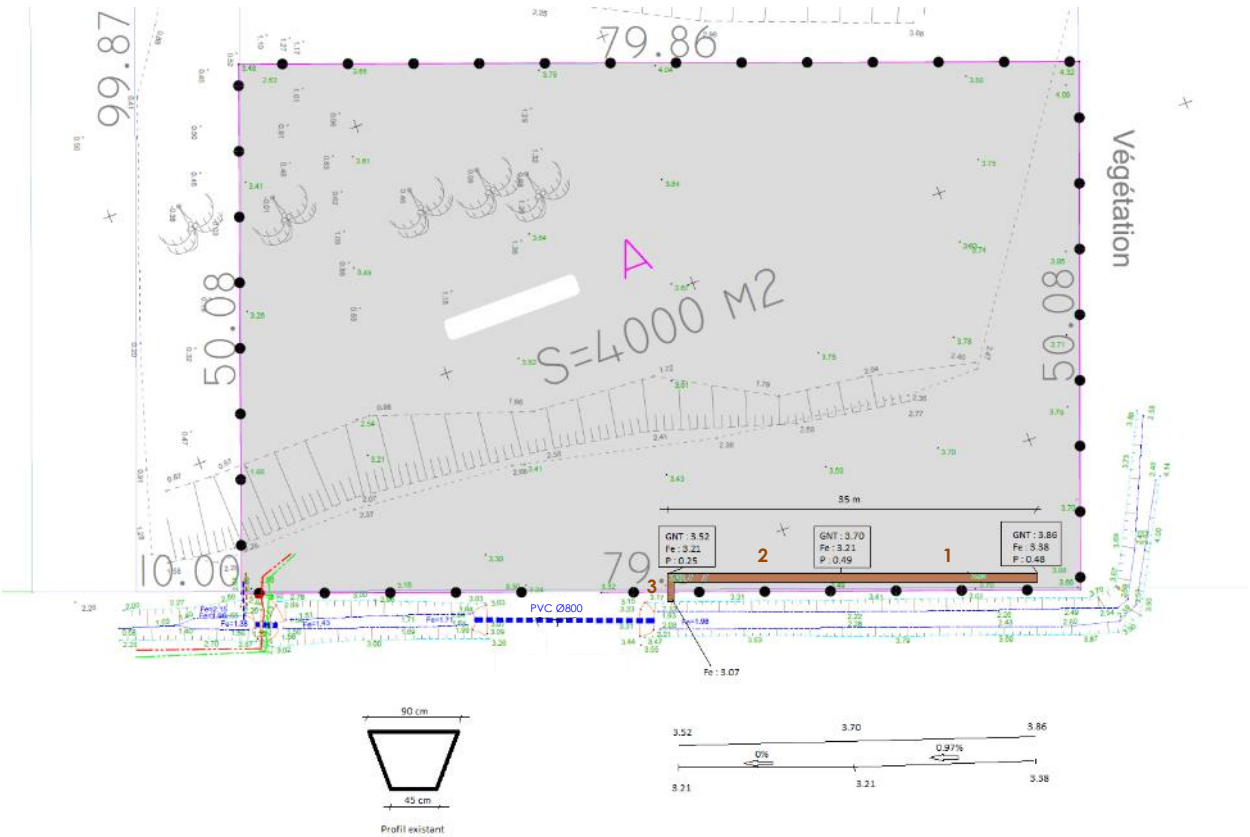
Plan des réseaux existants avec coupe longitudinale et transversale
